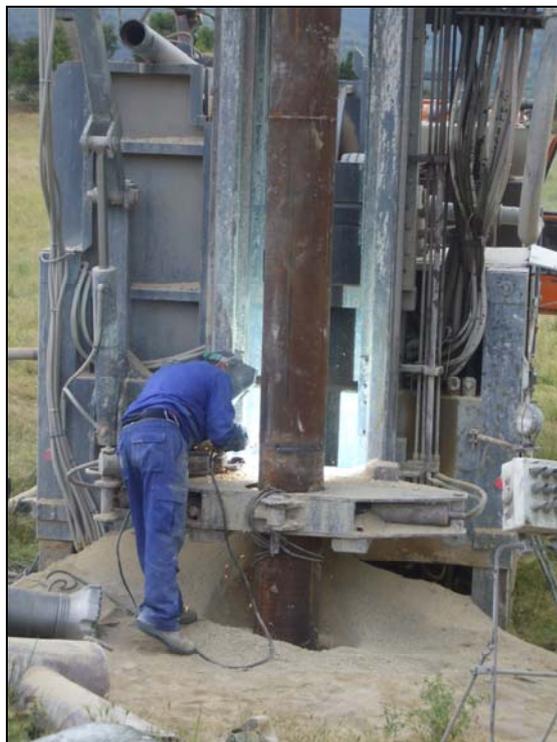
Soldadura de la tubería de emboquille.
